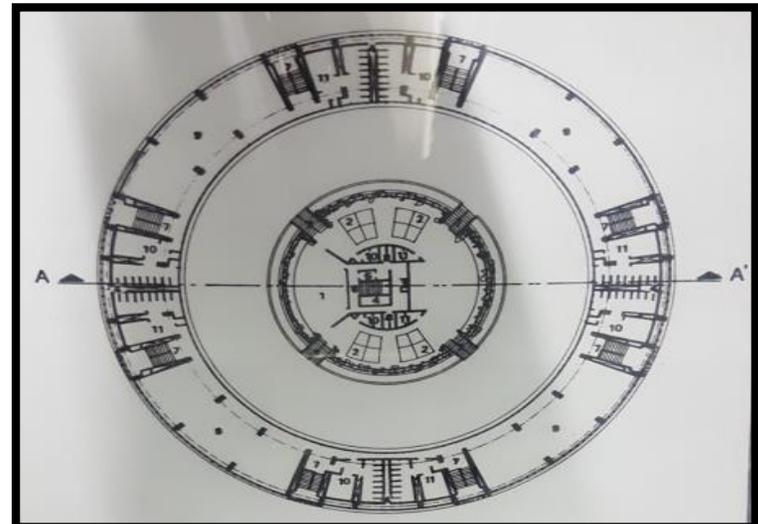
Plano de Planta Arquitectónica del edificio central.
